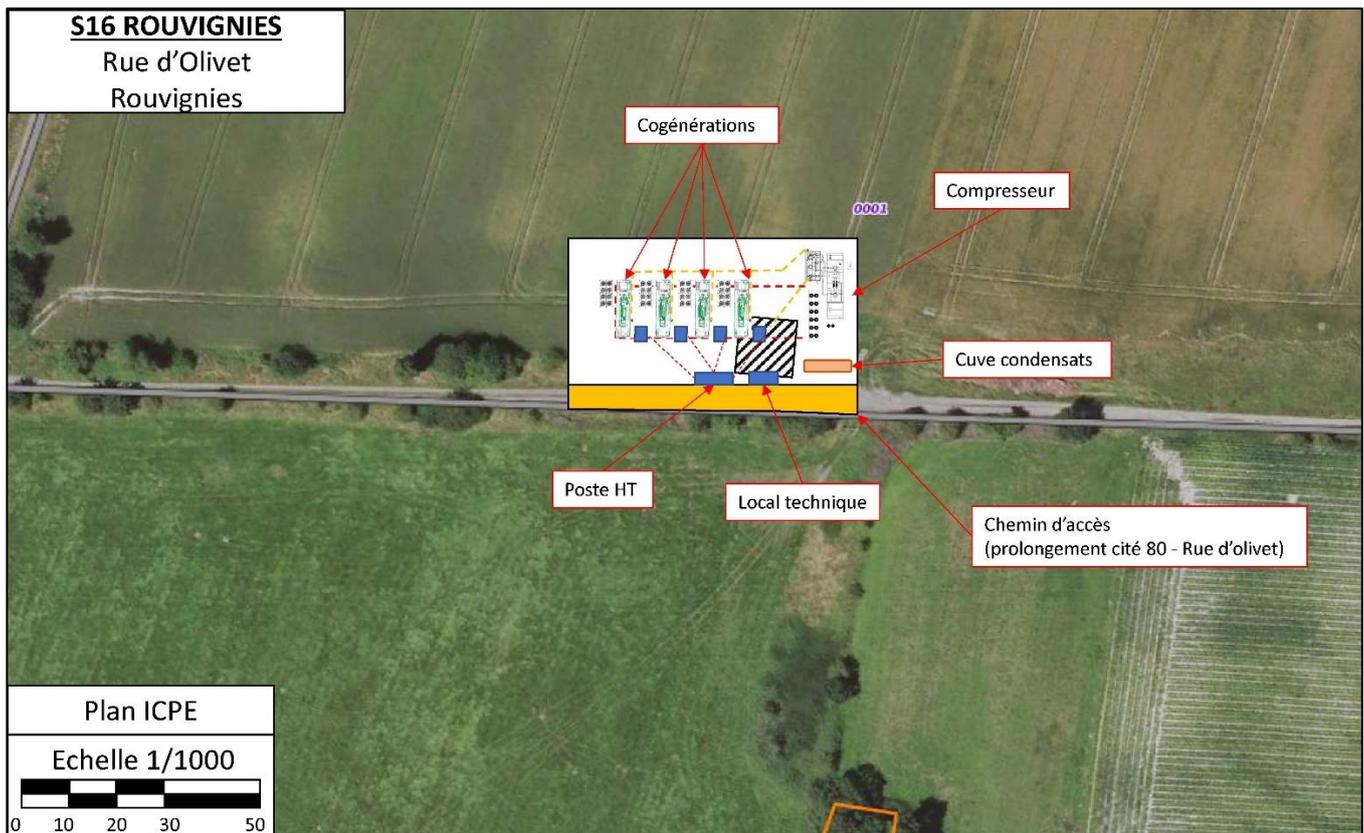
Plan de masse prévisionnel du futur site de captage S16 AZ 04
